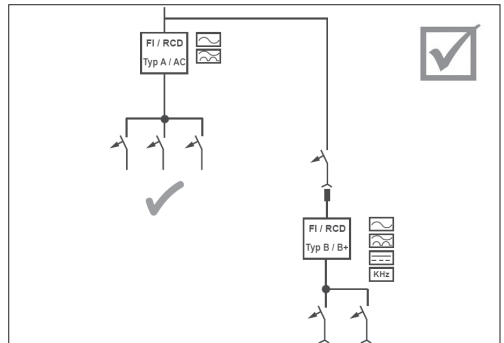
Installazione elettrica a regola d'arte (impianto di distribuzione domestico)
